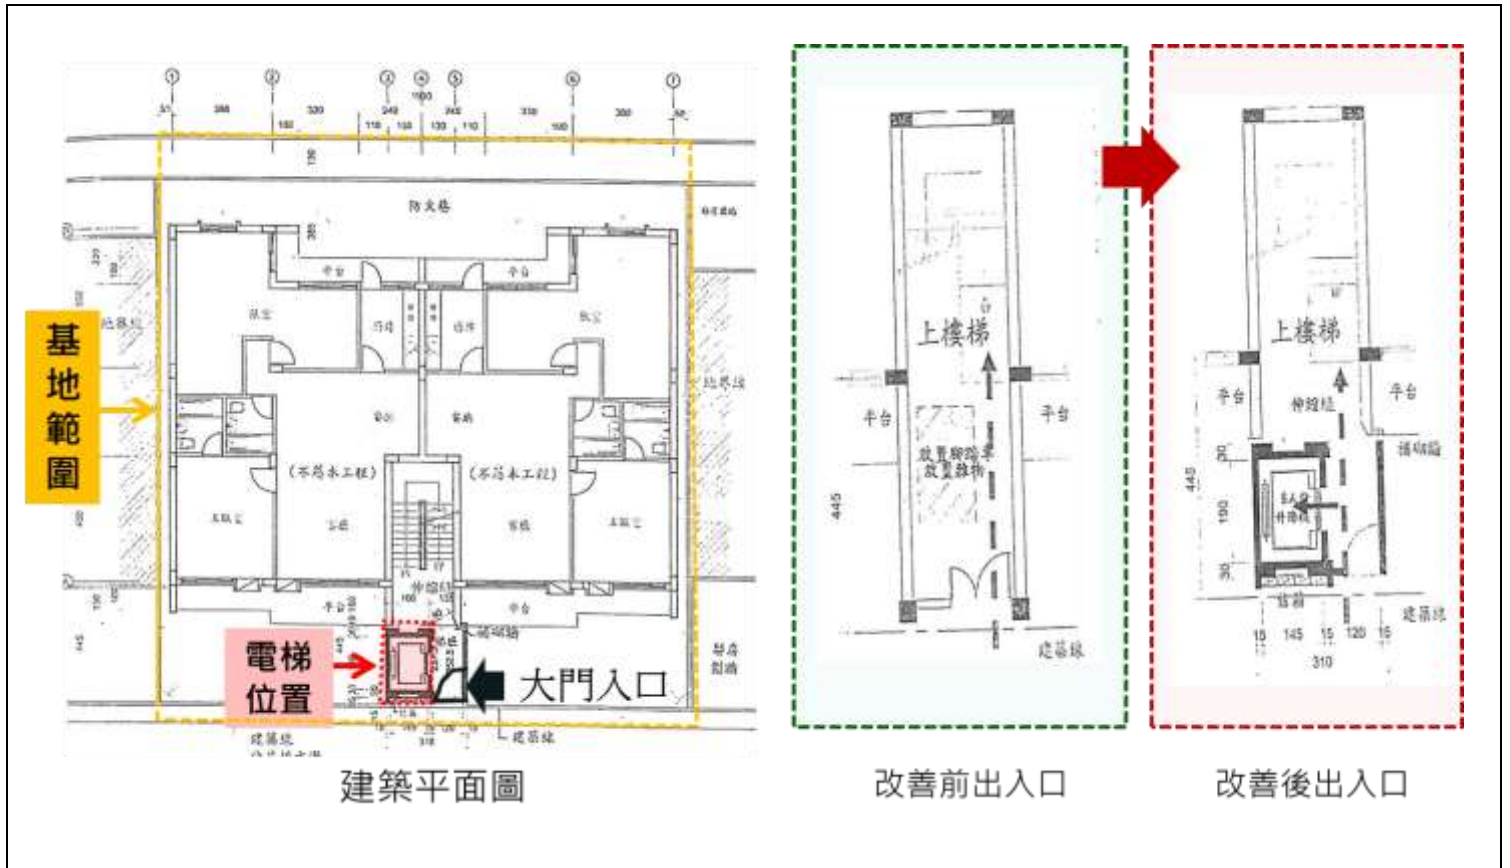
案例 2-1 昇降機增設位置說明示意圖
